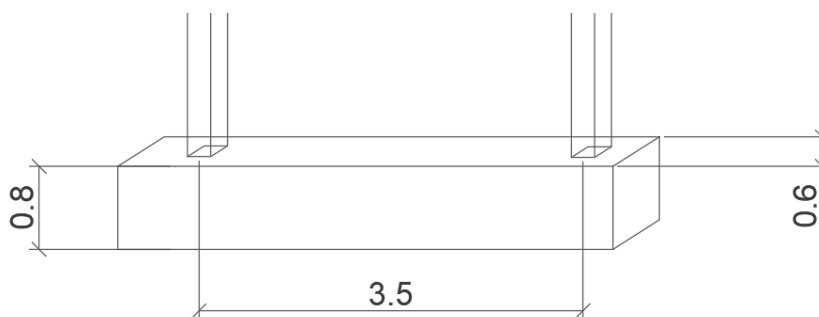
Dimensiones de la zapata y separación máxima entre pilares (metros)
